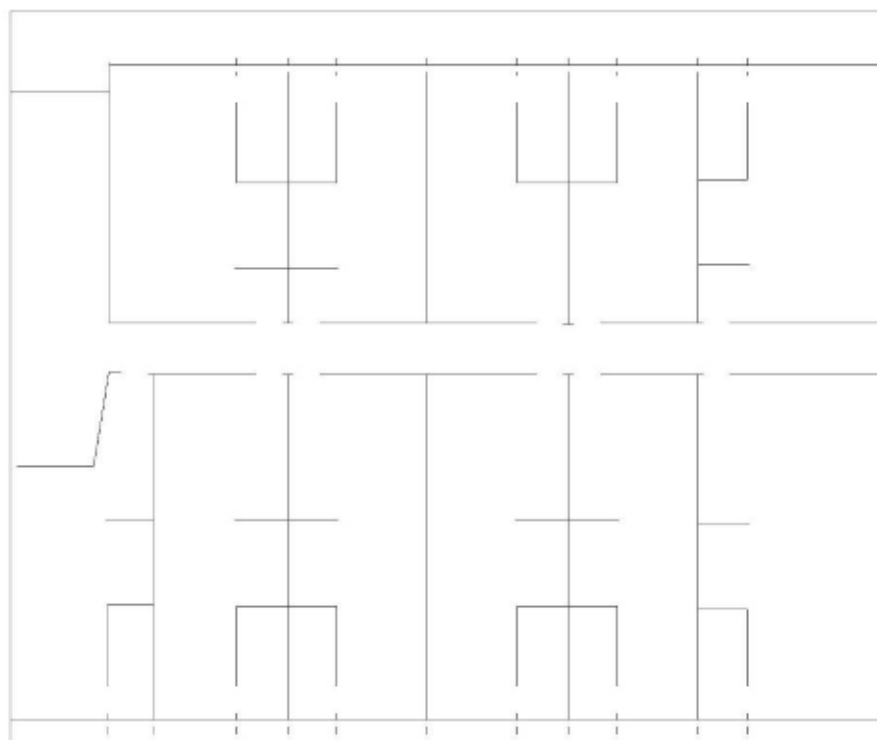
Planta baixa do quinto pavimento alterada para linhas
